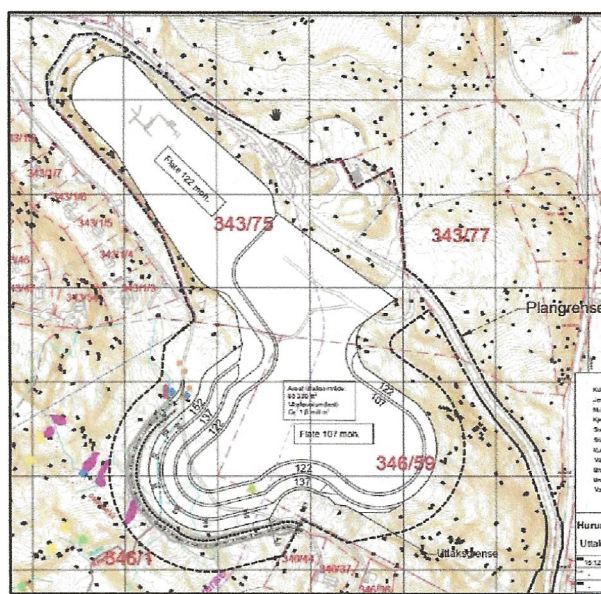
Alternativ 2 (planforslaget) - Fase 1
